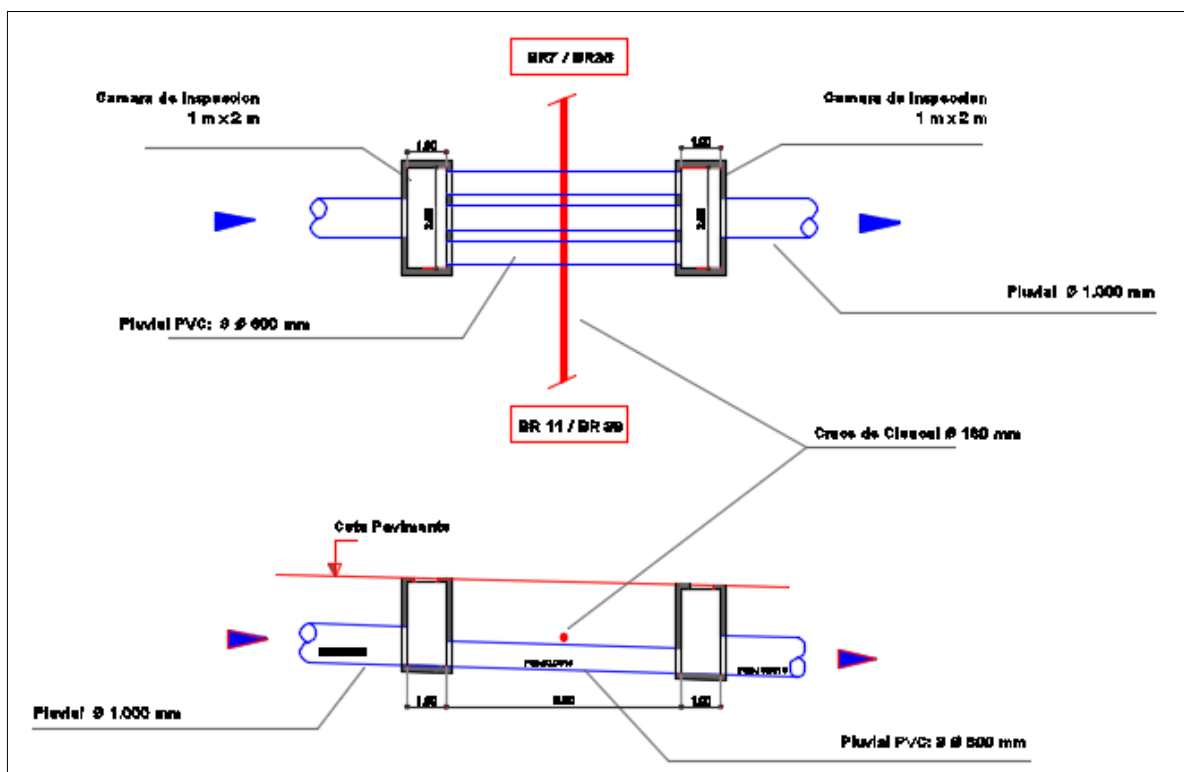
Cruce Pluvial bajo Red Cloacal
